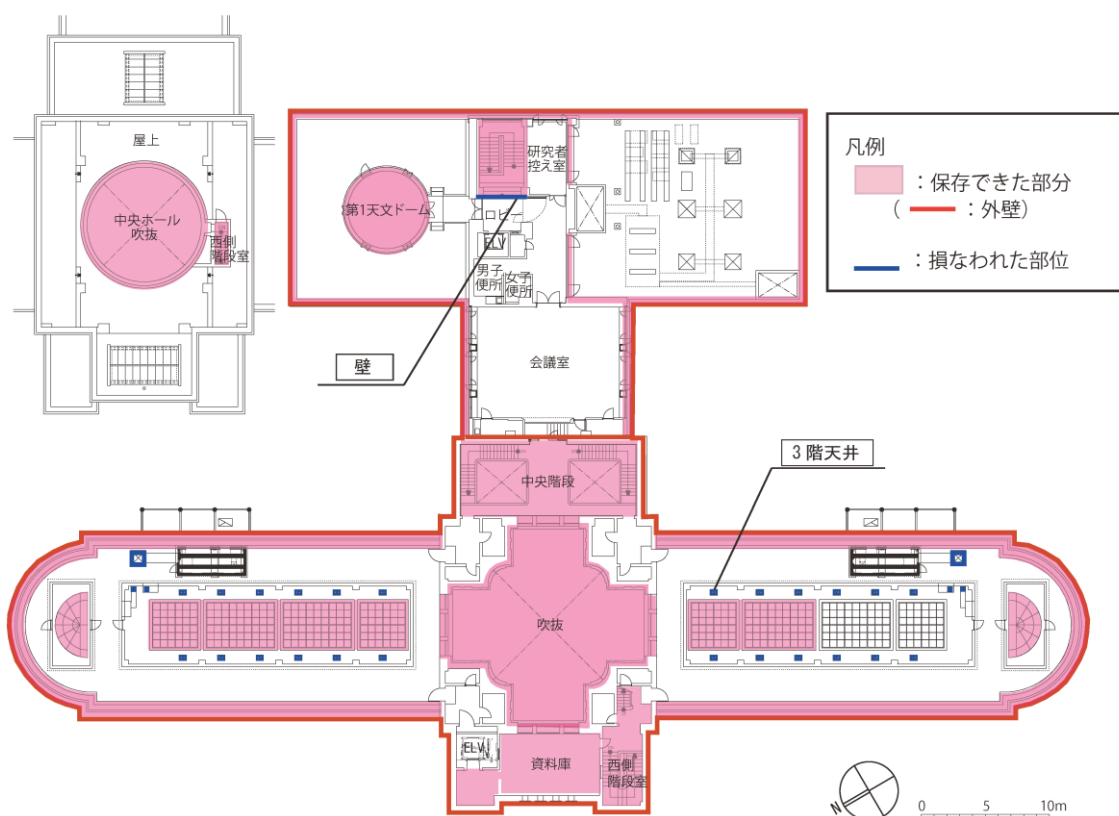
損なわれた文化財的価値 塔屋平面図（改修後 4 階平面図に筆者加筆）
